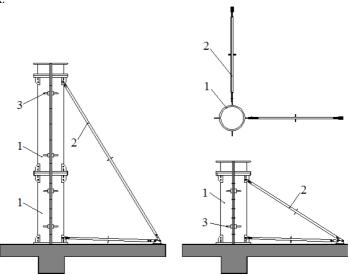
Схема устройства опалубки круглых колонн:
